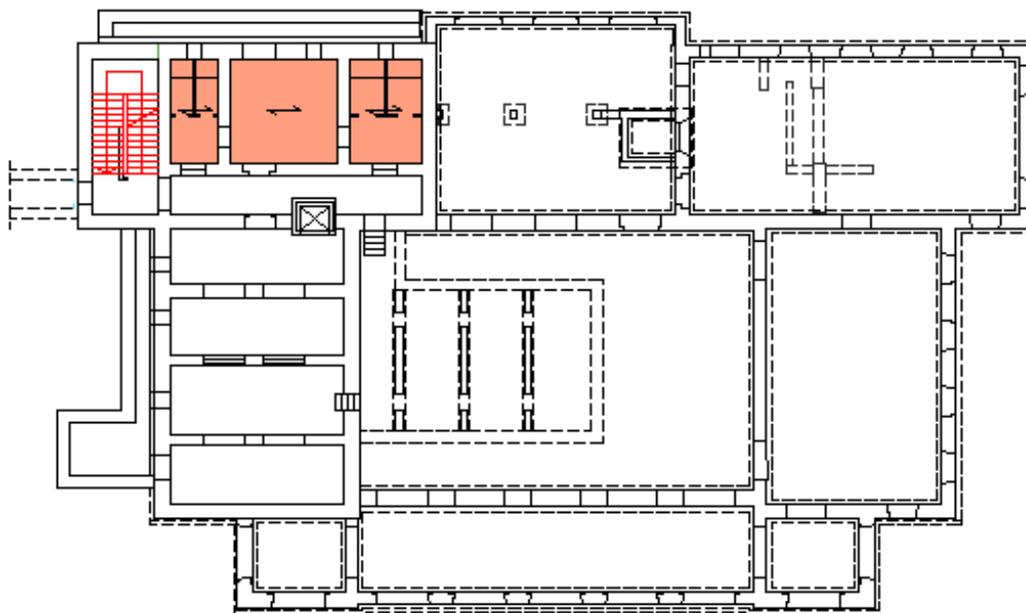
Pianta dei muri del piano seminterrato con individuazione del solaio in latero-cemento del piano terra
